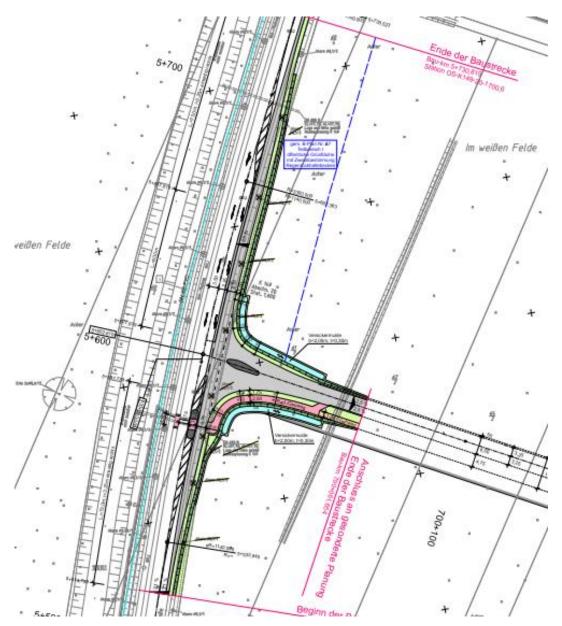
Dipl.-Ing. Dieter Linz GmbH & Co. KG, Wunstorf: Lageplan, Bebauungsplan Nr. 37 – höhengleiche Anbindung an die K 149, Vorabzug, Stand 07/2017
